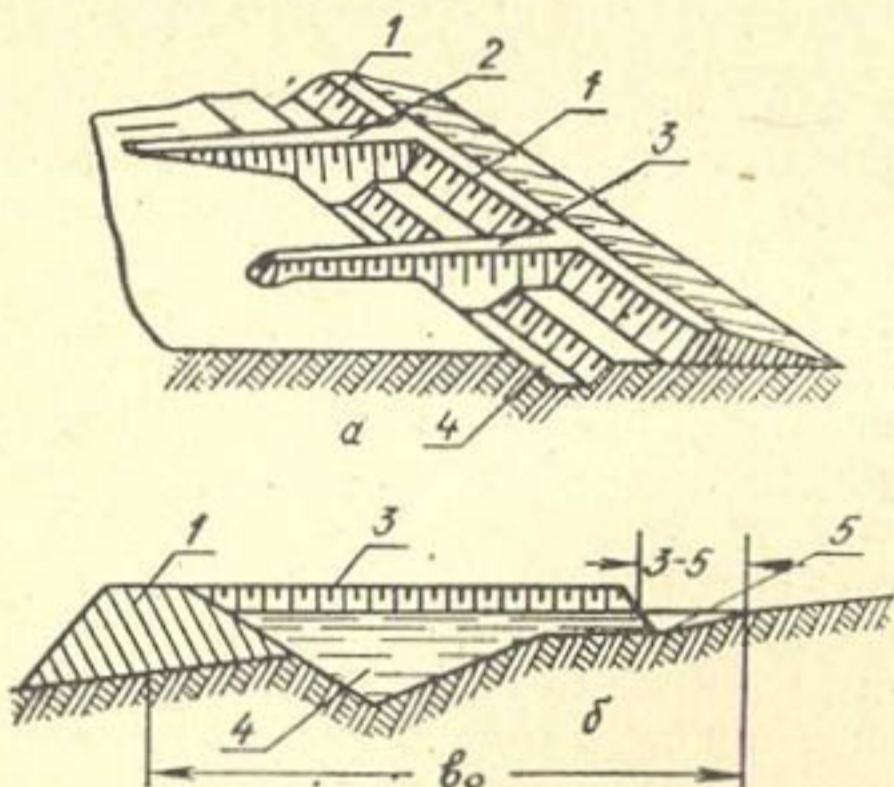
Схема открытой и глухой перемычки у вала-канавы (а) и конструкция водообхода в конце перемычки (б):
